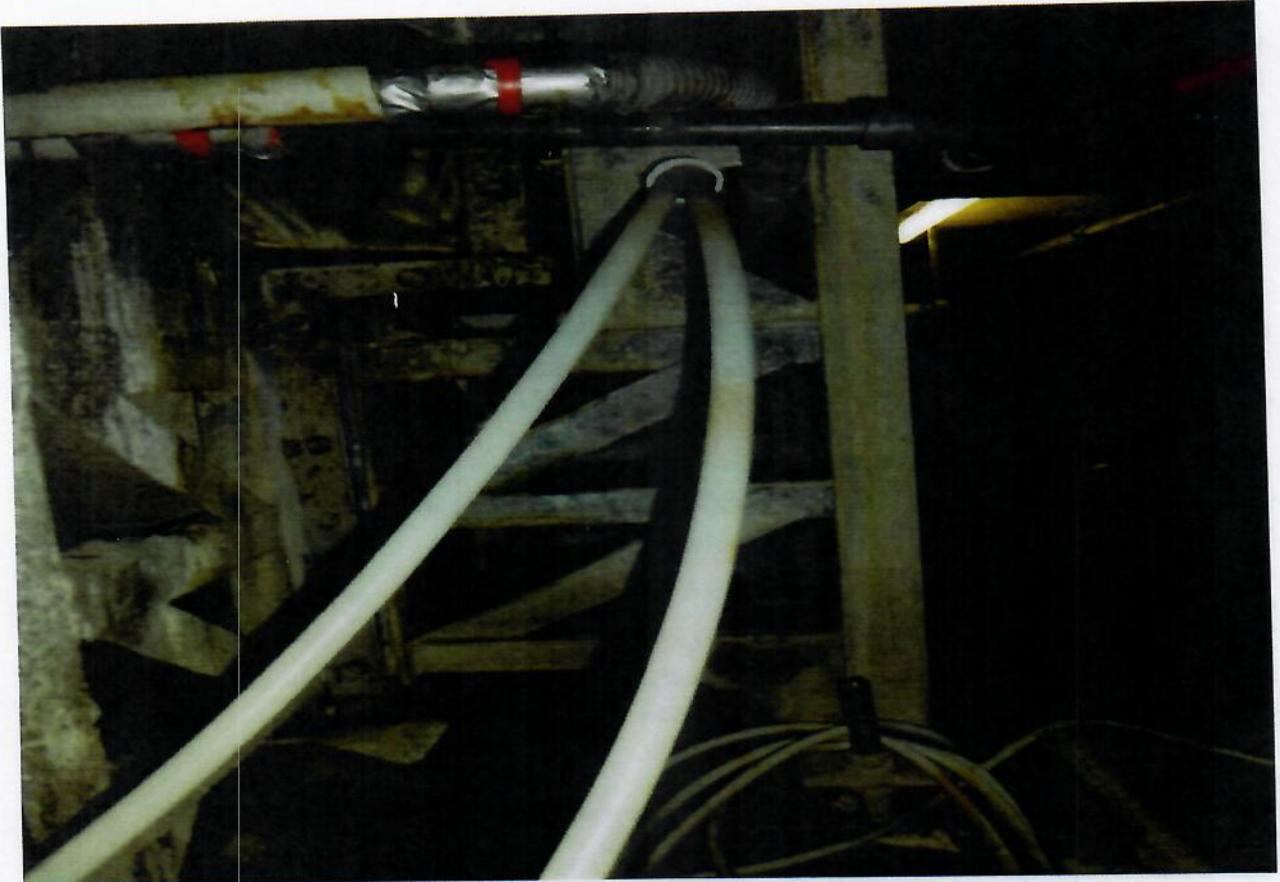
Becken 04: Korrosionsschäden an der Unterkonstruktion Becken
